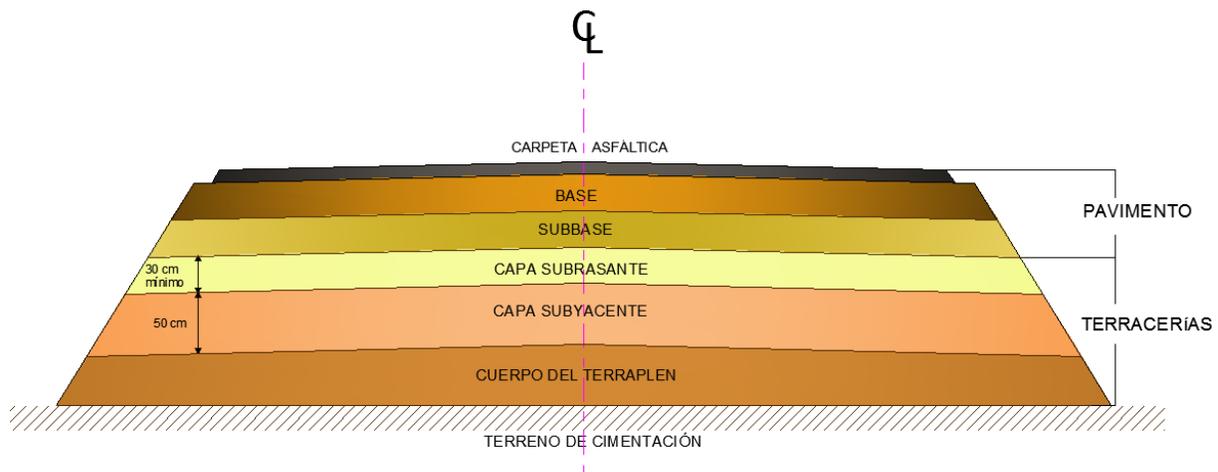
Sección transversal de terraplén con capa subyacente
